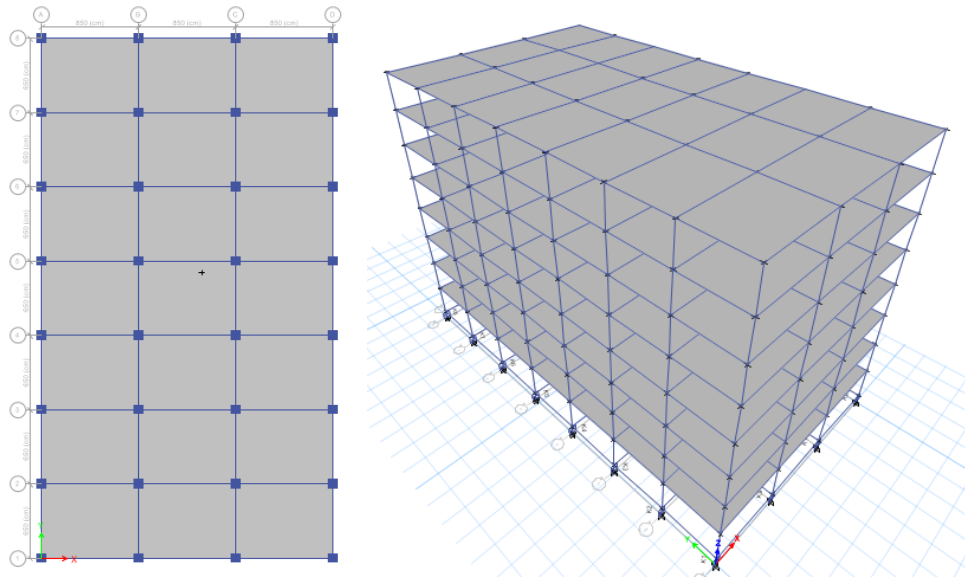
Vista en planta y 3D de modelo estructural rectangular.
